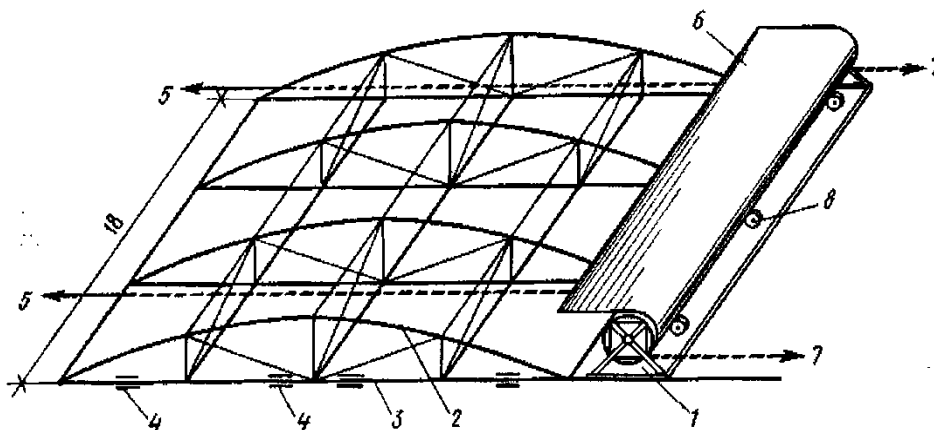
Схема кондуктора и разворачивания рулона в горизонтальном положении: 1 — стенд рулона; 2 — верхний криволинейный пояс кондуктора; 3 — нижний прямолинейный пояс кондуктора; 4 — поворотные шарниры; 5 — тяговые канаты лебедок (грузоподъемностью по 10 т) для разворачивания рулона; 6 — рулон; 7 — удерживающие канатные тяги (на трактор или лебедку); 8 — прижимные ролики
